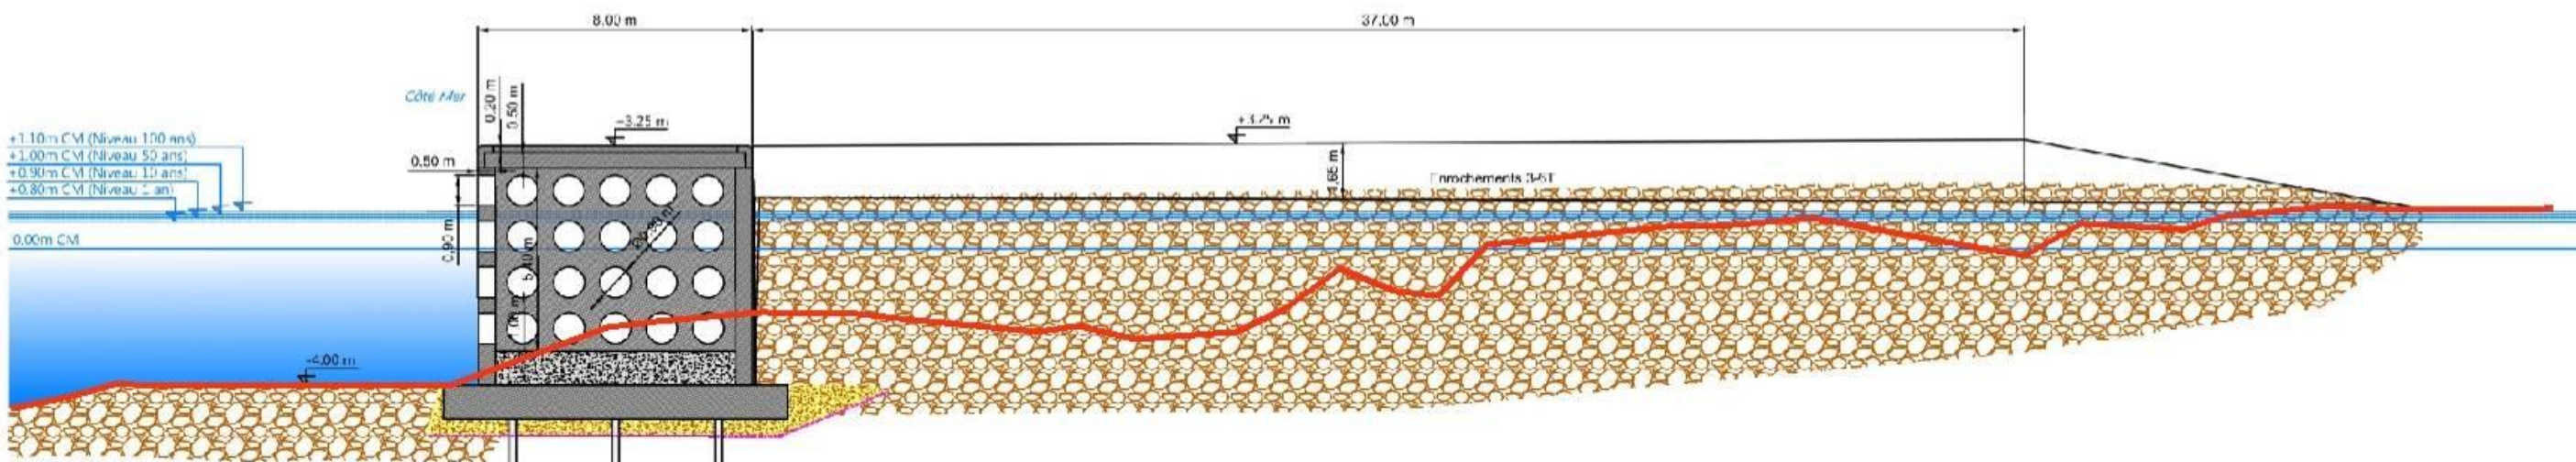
Tenon Ouest et digue solution caisson Jarlan – Coupe 1 - — : Profil du terrain actuel
